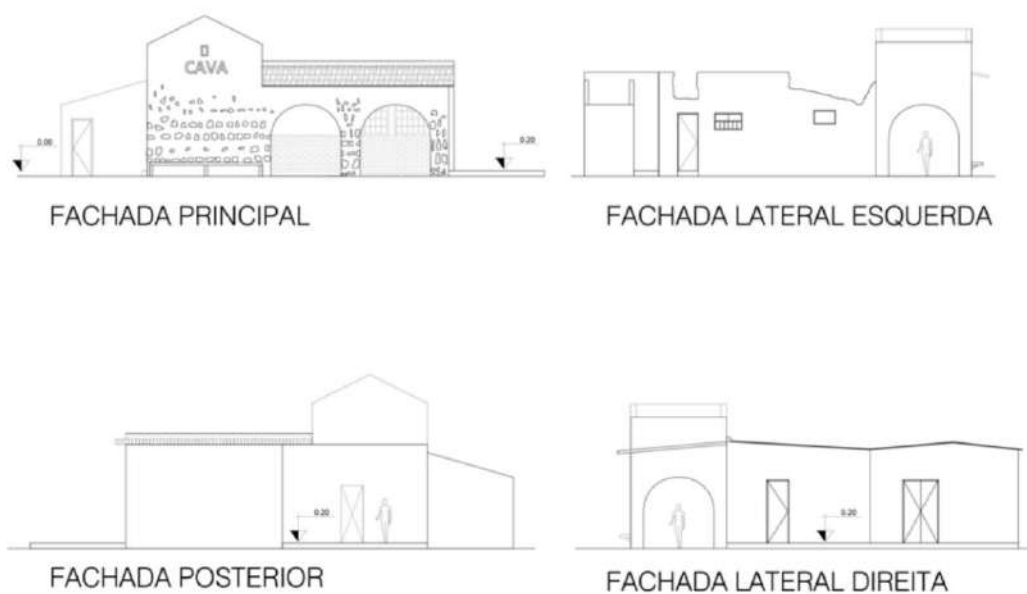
Levantamento Arquitetônico da estação Vila de Cava.
